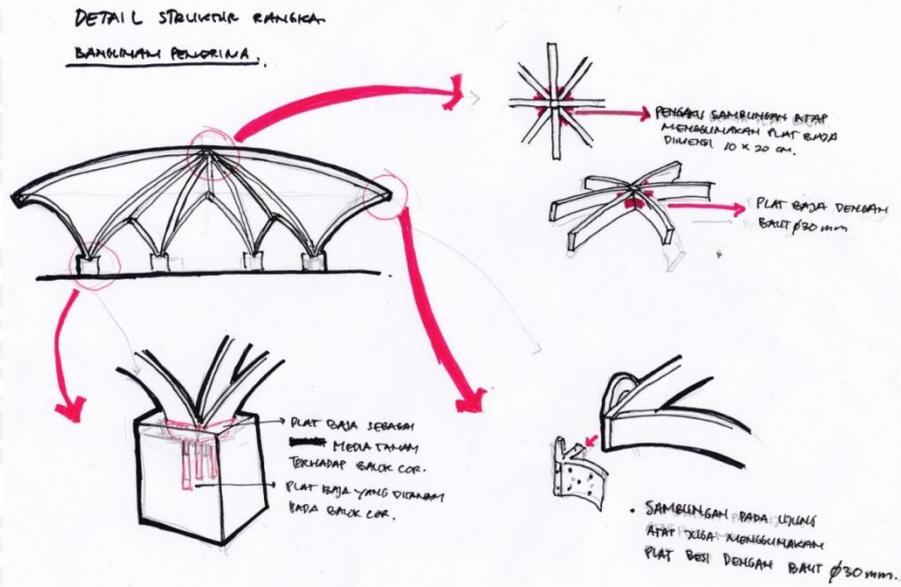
Sambungan Struktur dan konstruksi kolom dengan pondasi.
